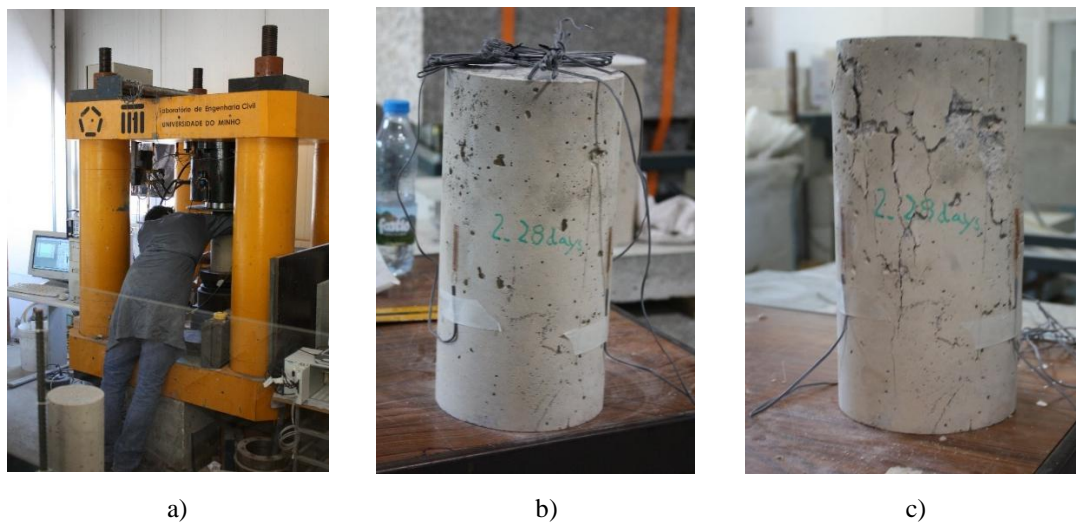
a) Aspeto geral da prensa; b) pormenor de um provete cilíndrico antes do ensaio; c) pormenor de um provete cilíndrico após rotura.
